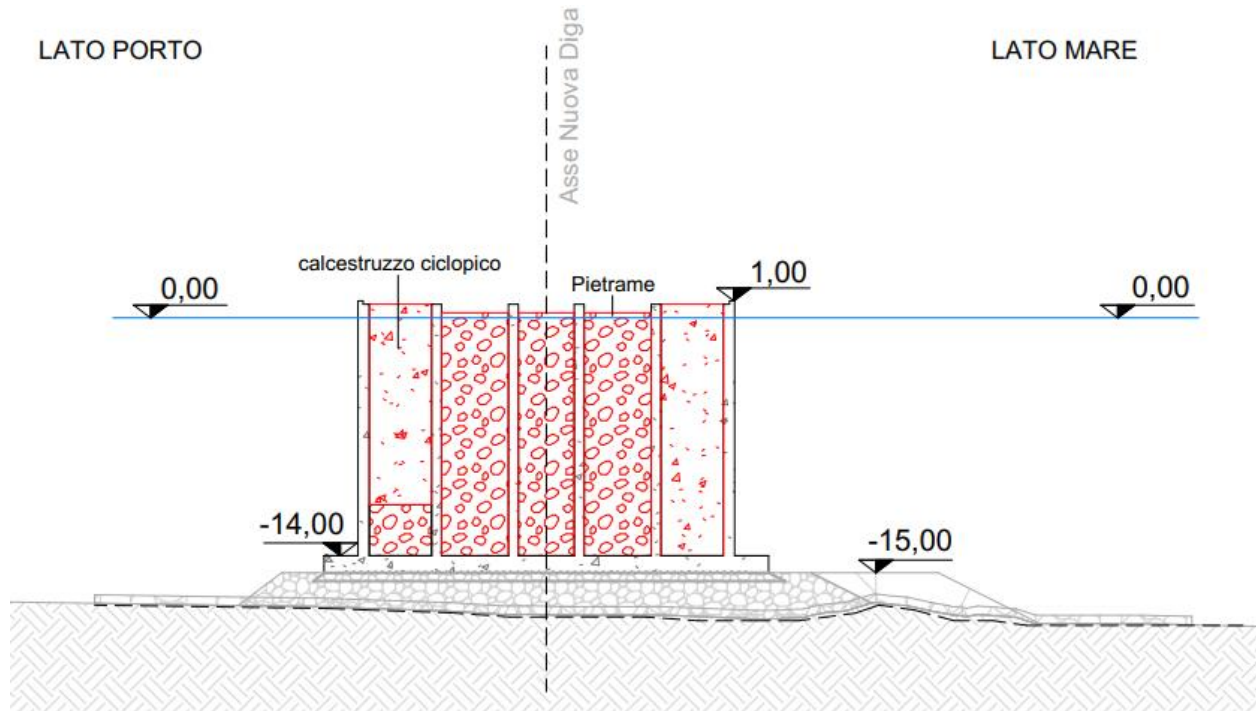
Fase 4.2 - Stabilizzazione con zavorra solida
